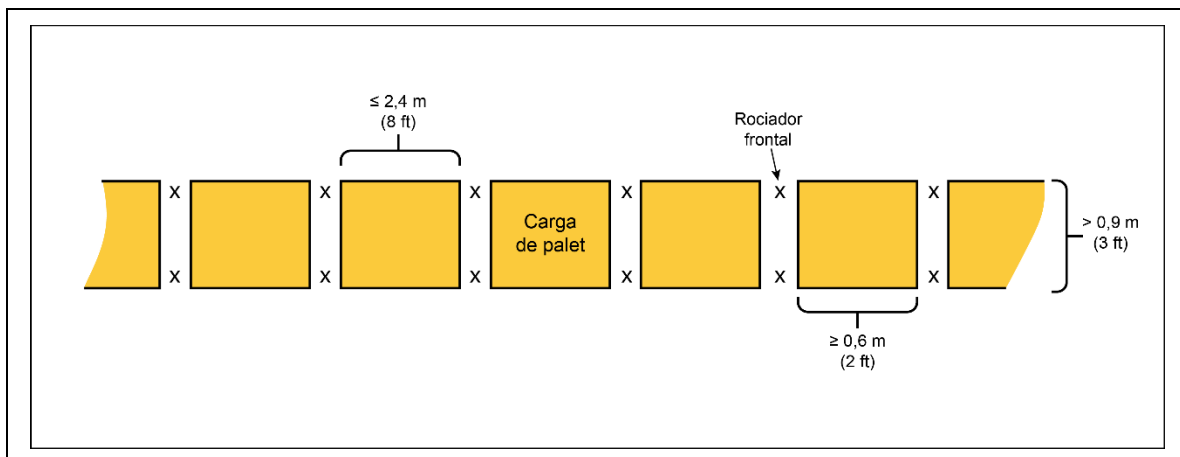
Vista en planta de una configuración horizontal de rociadores intermedios en cada chimenea transversal para estanterías simples cuya anchura sea superior a 0,9 m (3 ft)
